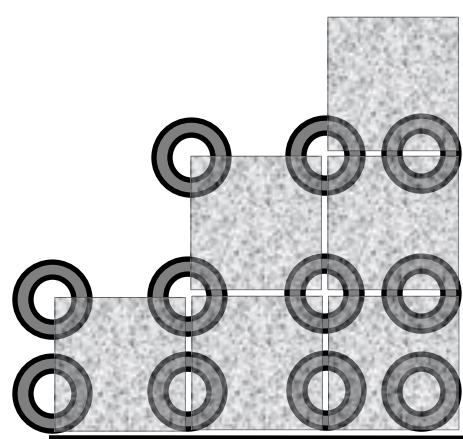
PLV50/75 Grundelement mit einem ZSt65/100, Stelzenhöhe von 135-170 mm verstellbar. Holzbelag.
